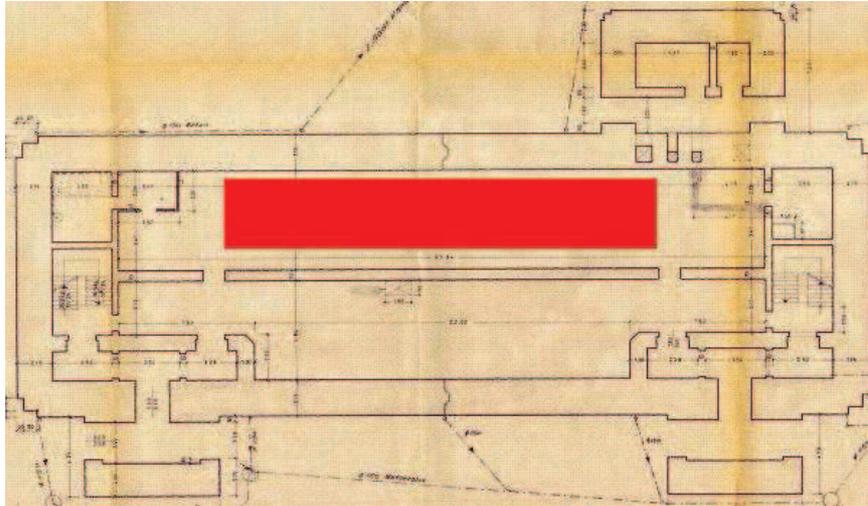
, Grundriss EG und 1.0G
